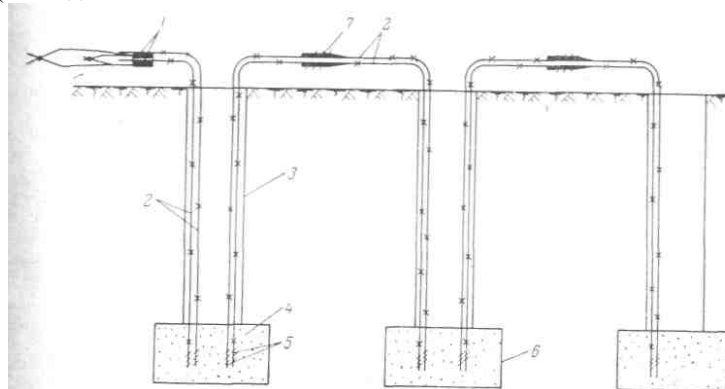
Схема последовательной взрывной сети из детонирующего шнура:
